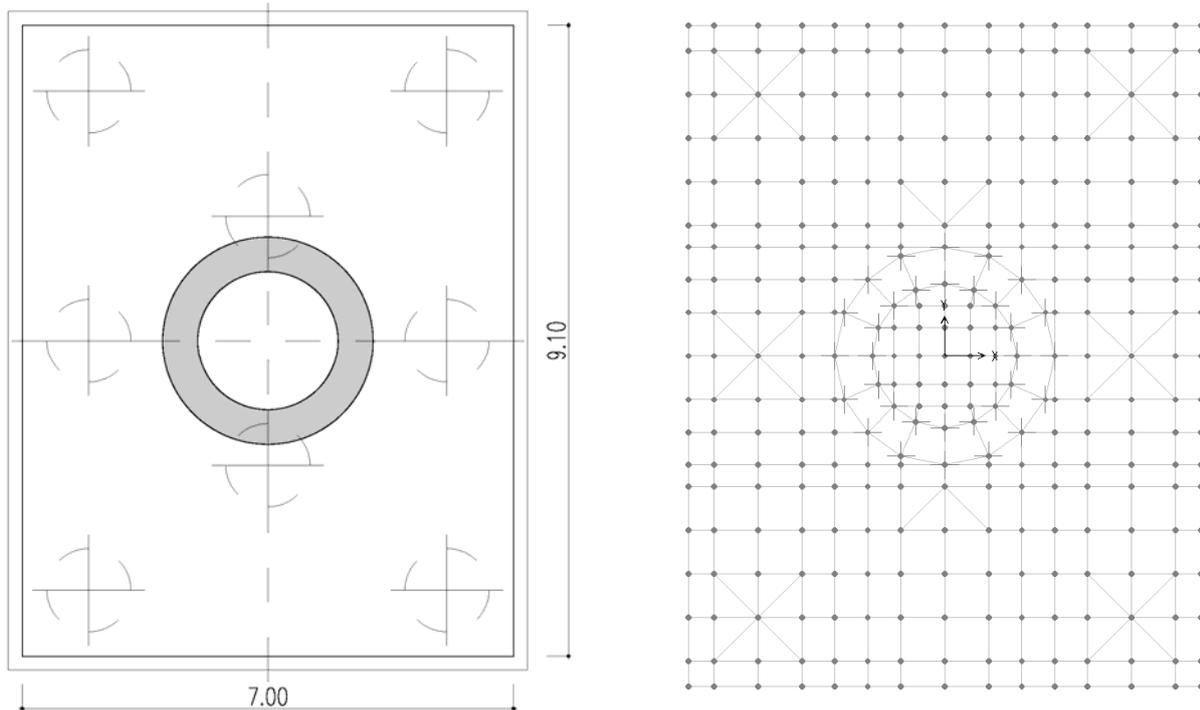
Plinto di Fondazione P01 carreggiata DX
